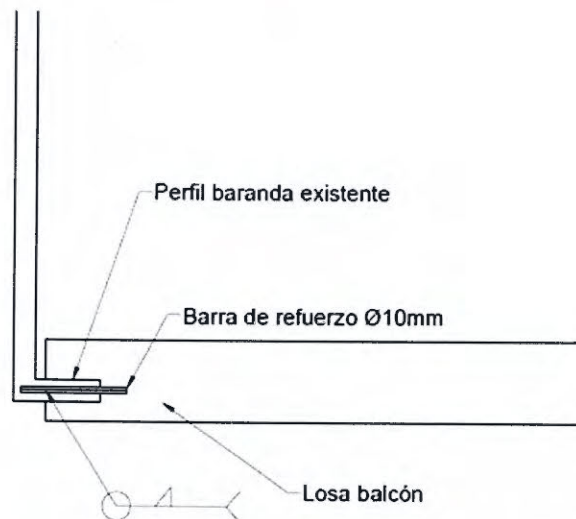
Esquema Mejoramiento anclaje inferior en barandas.
